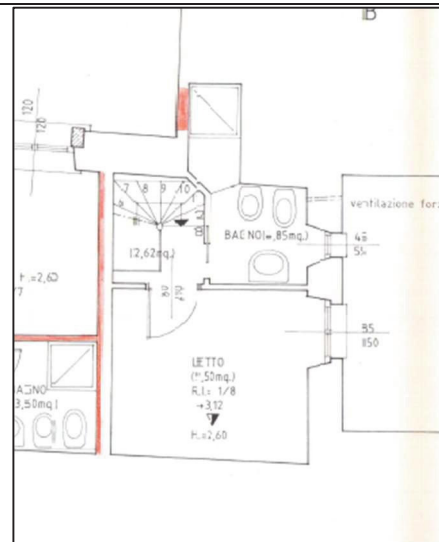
porzione dell'abitazione occupata dalla [redacted] al piano mezzanino rappresentata sulla tavola grafica allegata alla Concessione 2441/93
